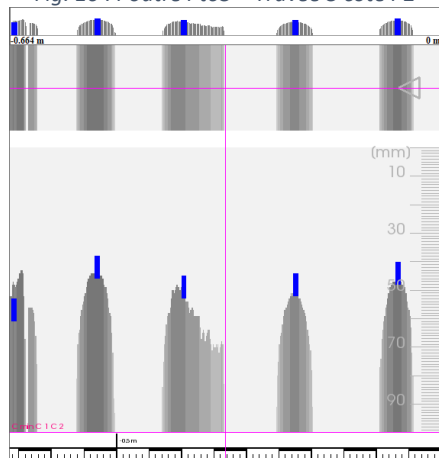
Poutre Pt01 – Travée 3 à mi-travée
